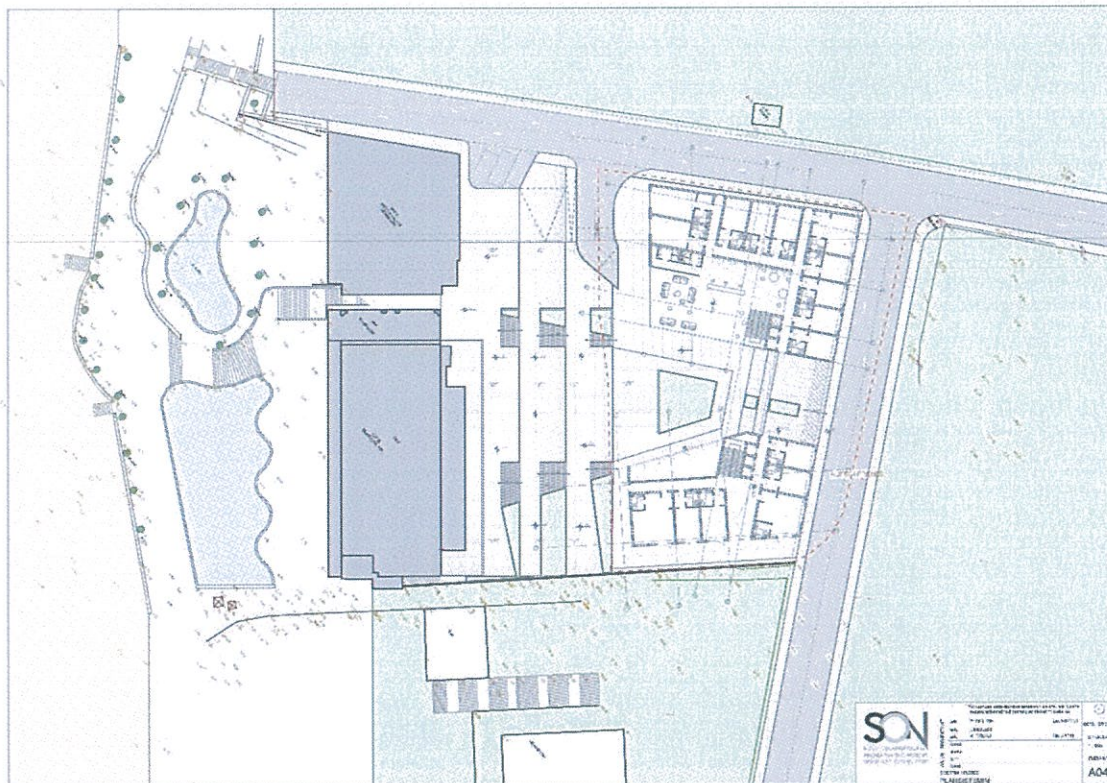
Plani i sistemimit dhe akset e kalimit.
